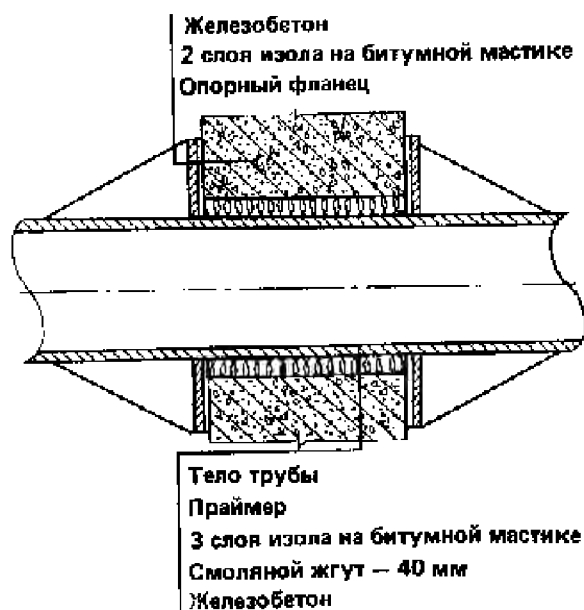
Изоляция трубопровода в футляре неподвижной опоры
